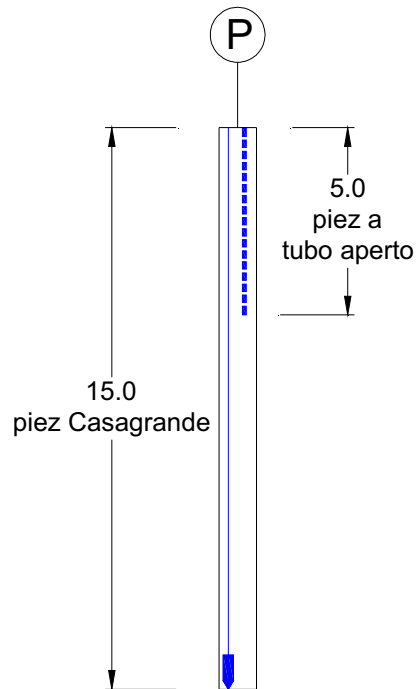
Schema installazione piezometri nella singola verticale Pi.
